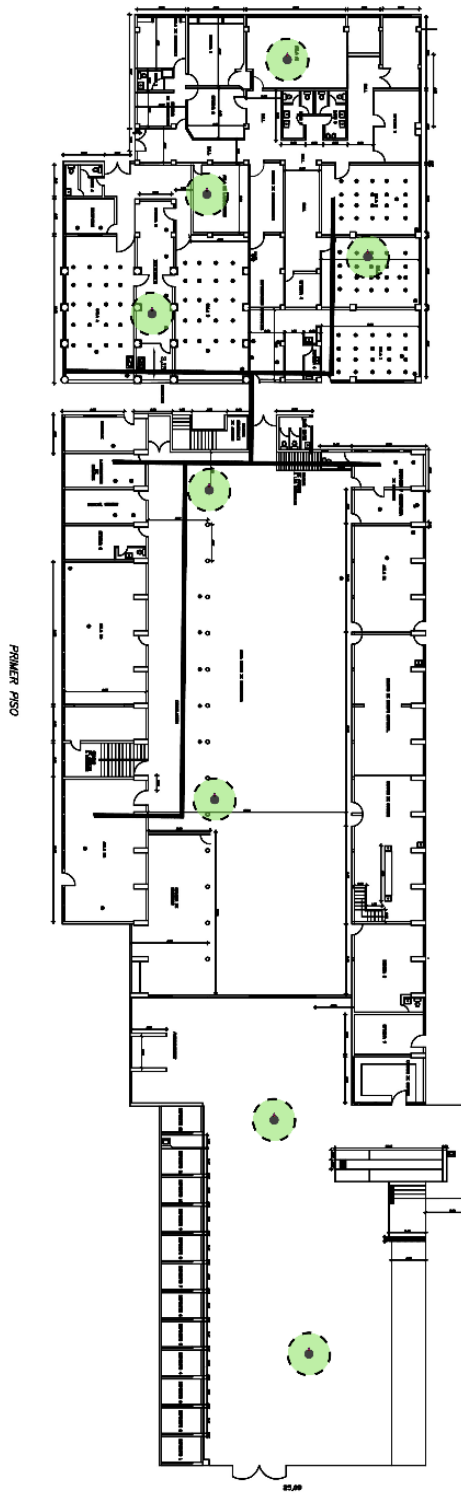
Ubicación de Access Points Edif. Ensayo Materiales Planta Baja
